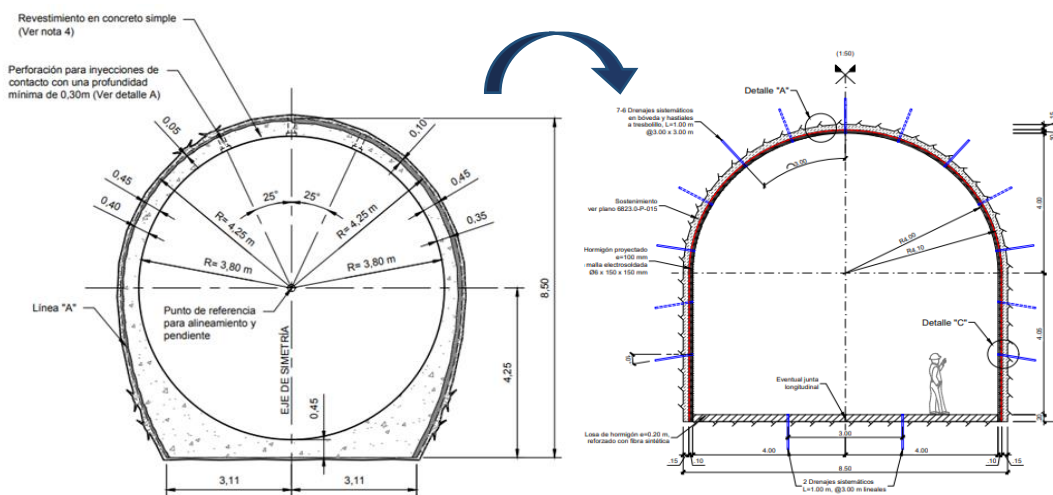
Cambio de sección en túneles (Autor: Fuente Propia)
